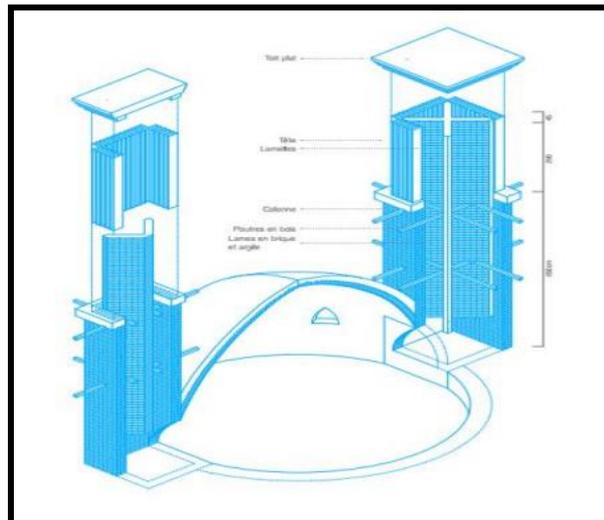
coupe transversal du Badgir .Source: (Boloorchi 2014)
